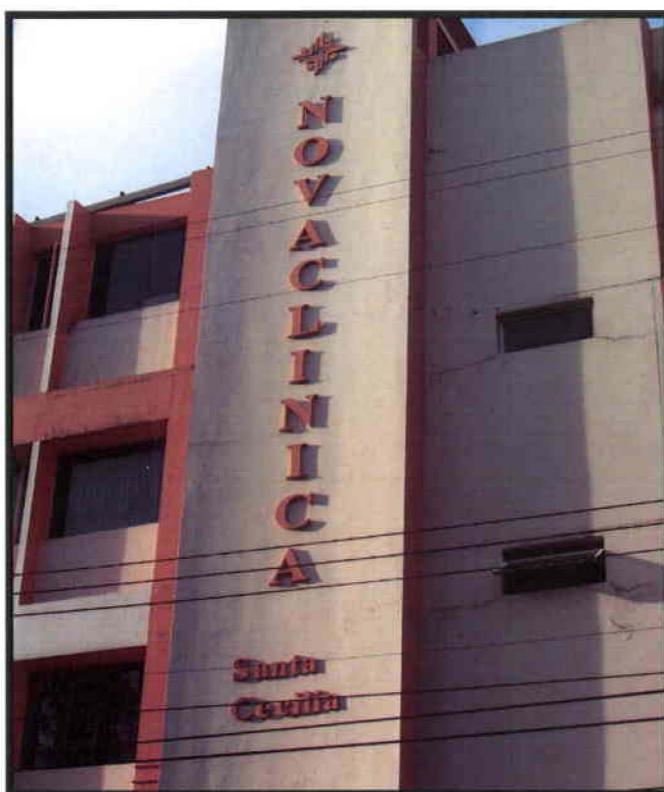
"NovaClínica Santa Cecilia" Fachada Frontal
